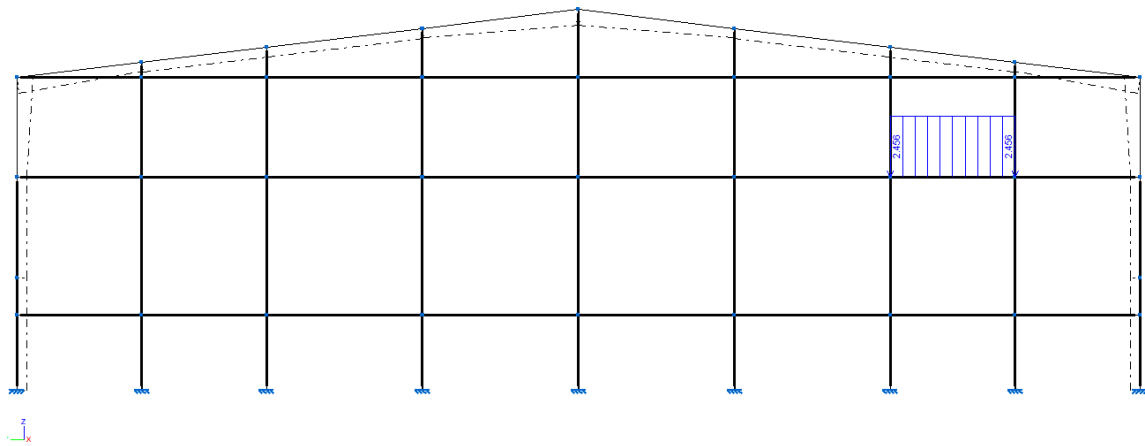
Carga cubierta tanques sobre pórtico posterior ($h=8,50m$)
